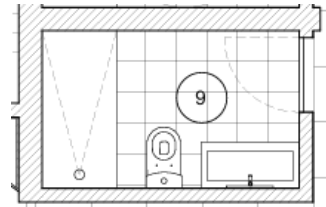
Instalação sanitária de serviço 2, excerto da planta de apresentação
